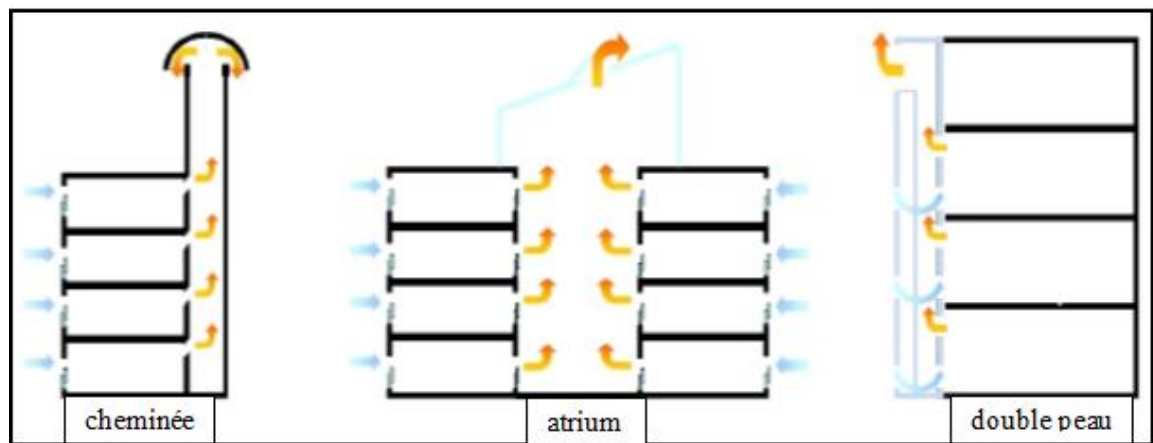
Solutions architecturales favorisant la ventilation traversant.
